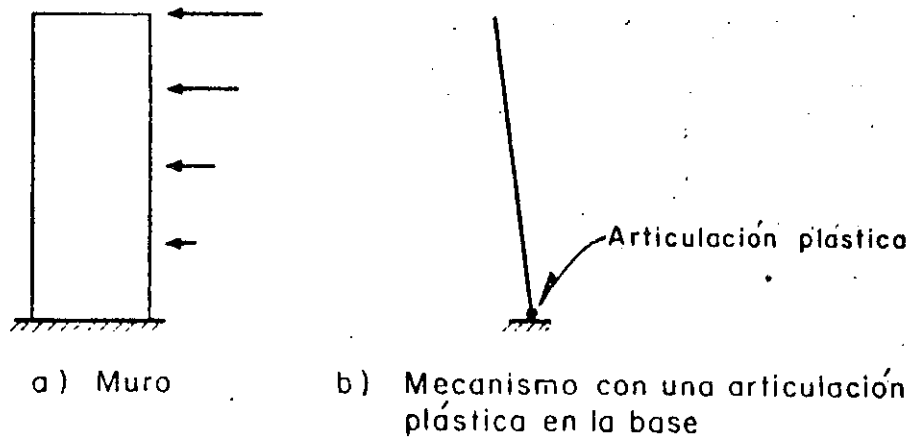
Mecanismo de falla de un muro de rigidez aislado sujeto a cargas laterales
